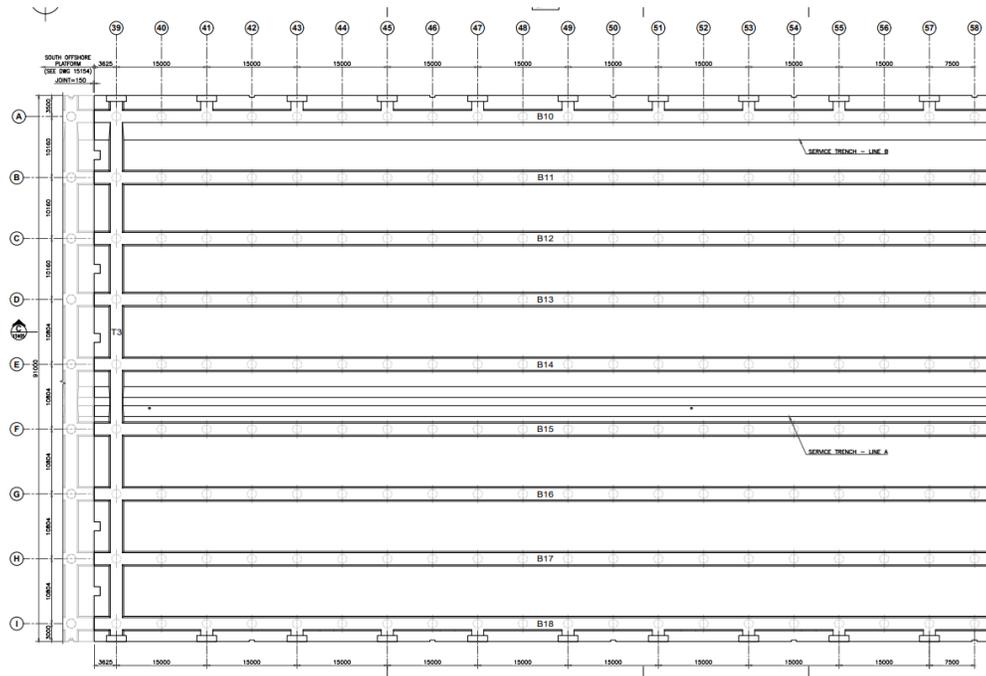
Plano general de vigas Q1/Q2 costado norte. Fuente: Cotema
